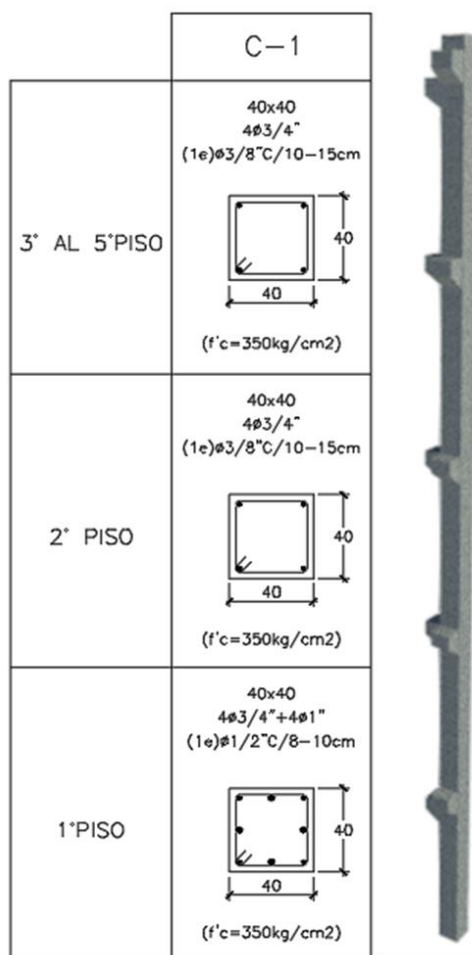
2. Disposición del armado longitudinal de columna prefabricada C-1
